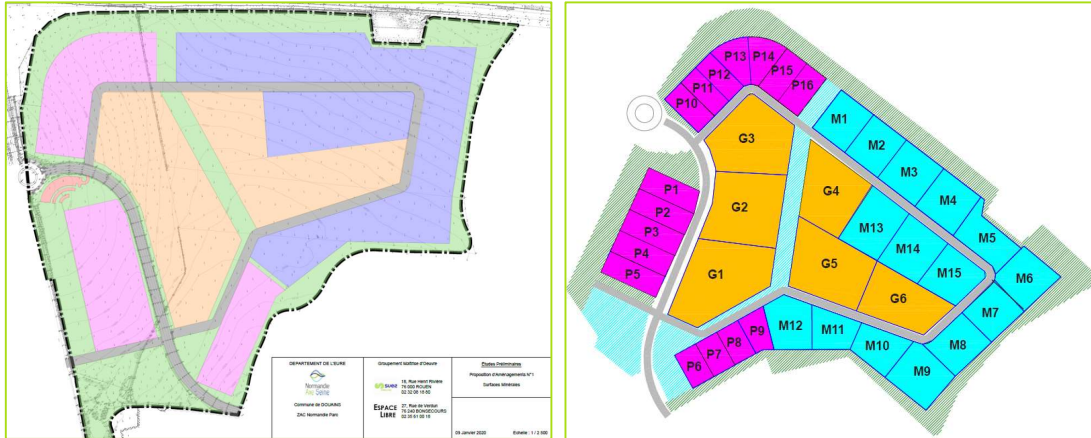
Proposition de plan masse avec découpage parcellaire (Source : Espace Libre/SUEZ Consulting – janvier 2020)
